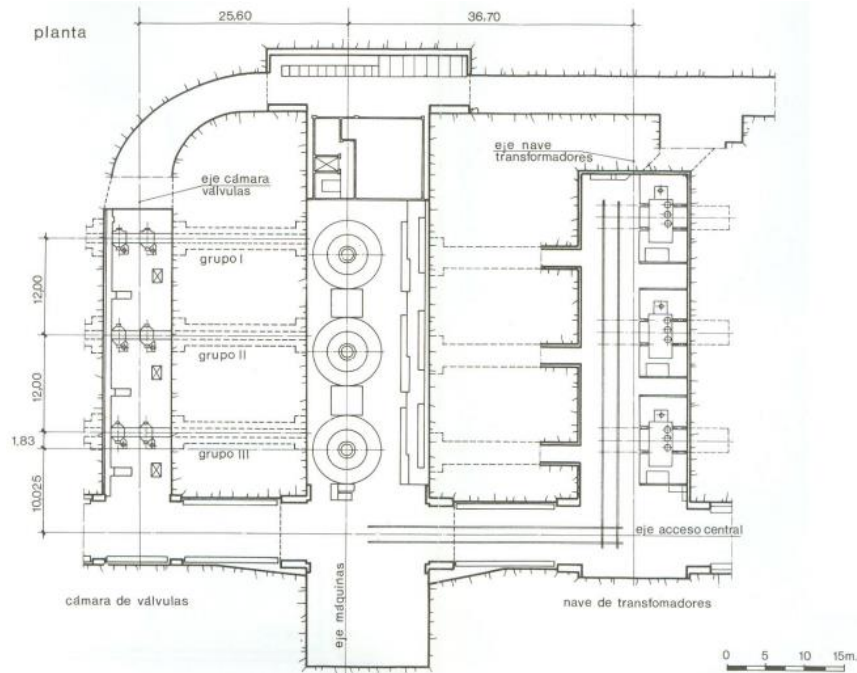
Vista en planta caverna de máquinas, central Moralets. Fuente: ENHER.
